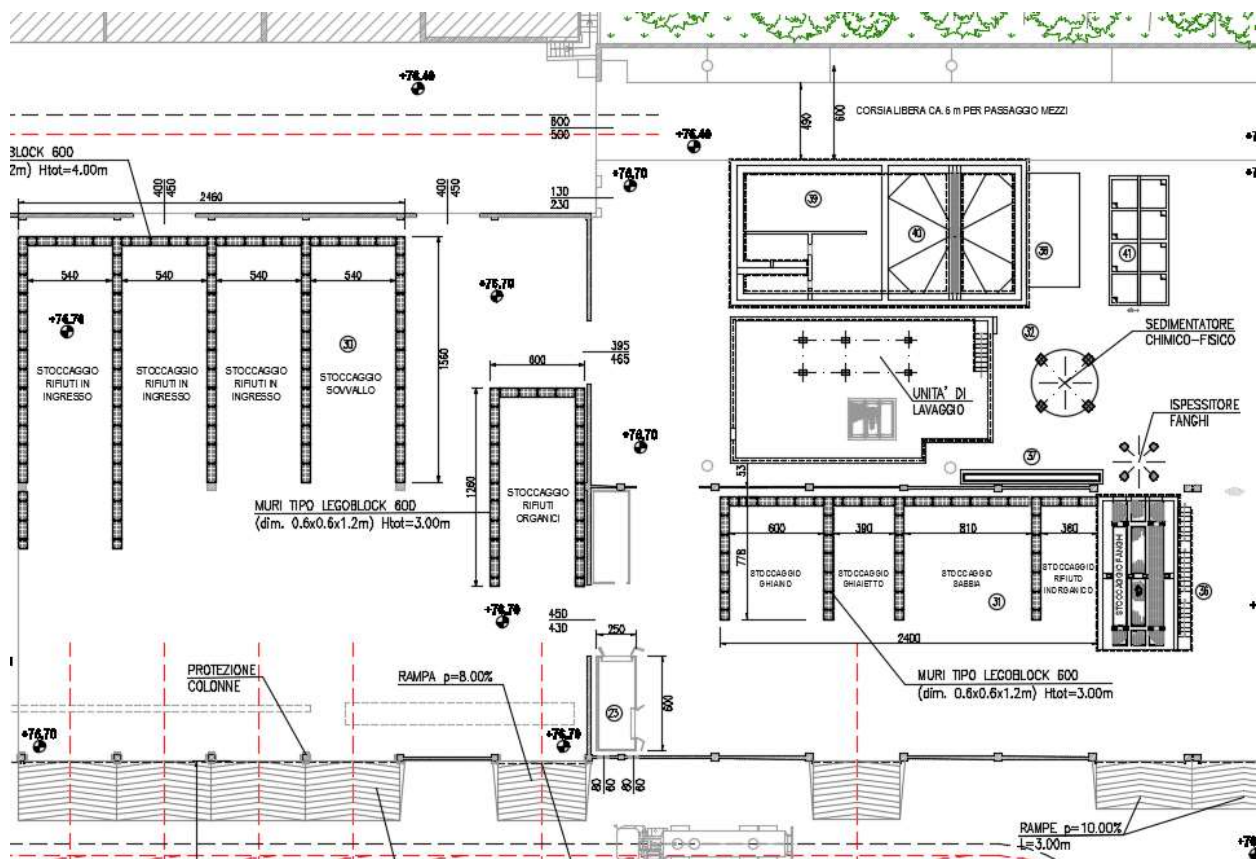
vista planimetrica impiando soil washing (opere edili)
